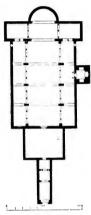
S. Prassede in Rom. Grundriss.
